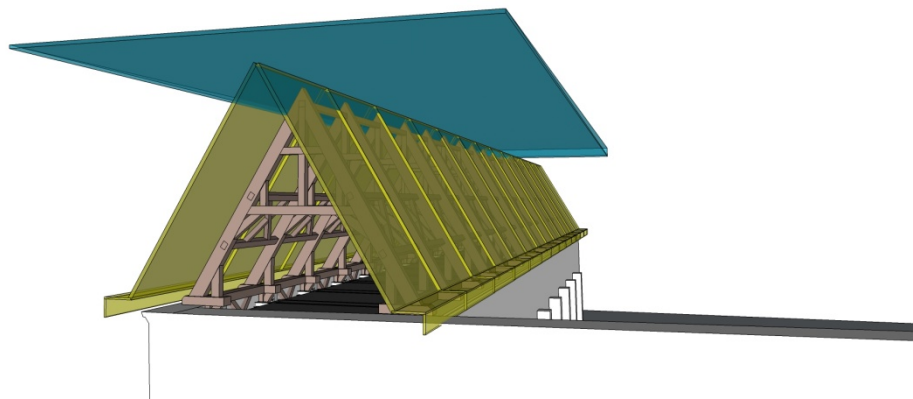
Idée d'une toiture couvrante l'espace de travail.
